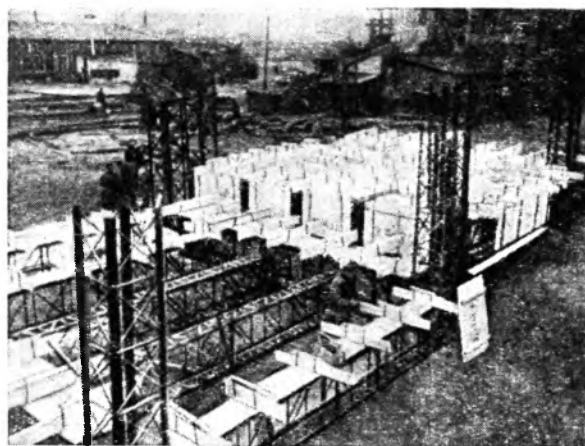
Изготовление арматурно-опалубочного блока панели перекрытия, состоящего из балок, ригелей и колонн.
